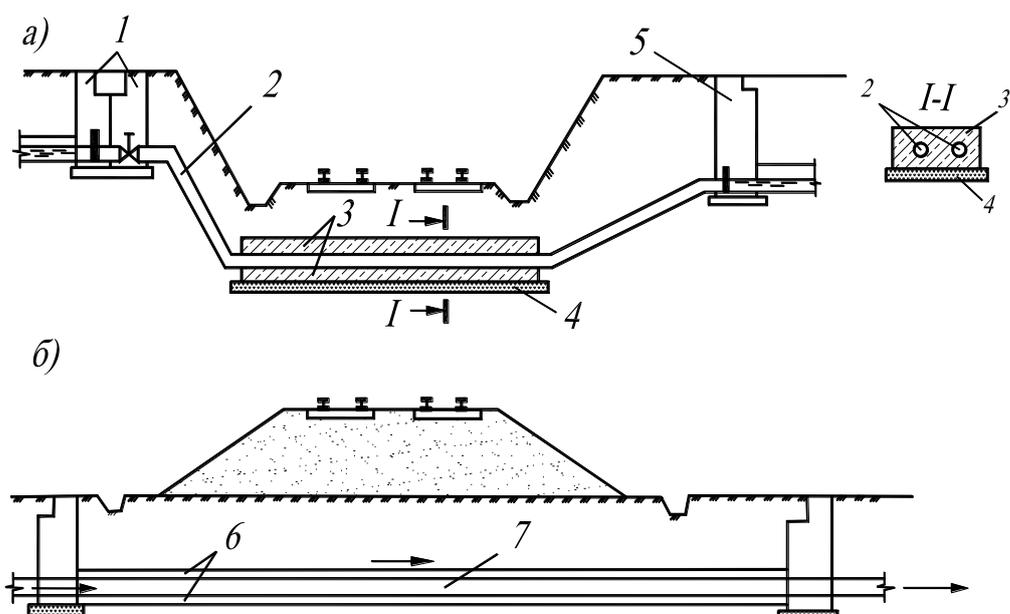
Схемы устройства пересечений водоотводящих трубопроводов с железнодорожными путями уложенными:
